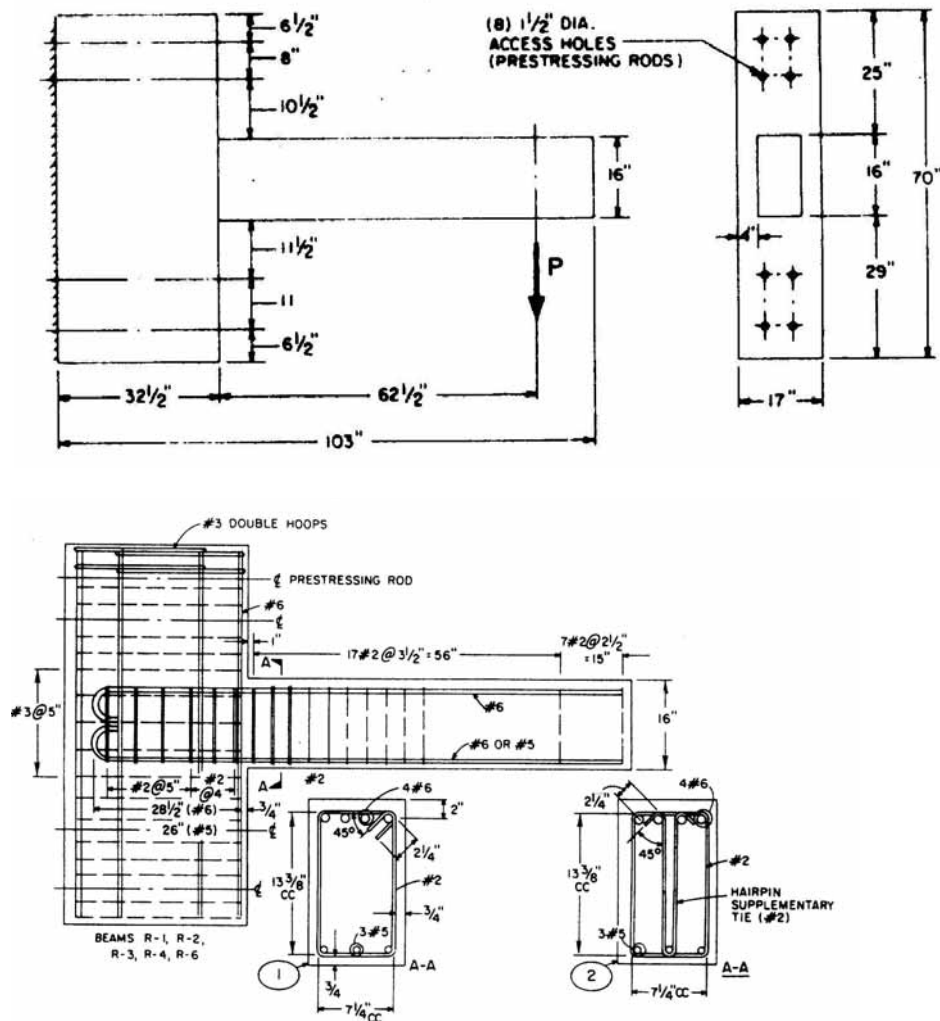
Propiedades geométricas del espécimen R-4 : a) Sección transversal. Armaduras longitudinales y estribos b) Dimensiones en planta y disposición de estribos (*Ibidem*)
